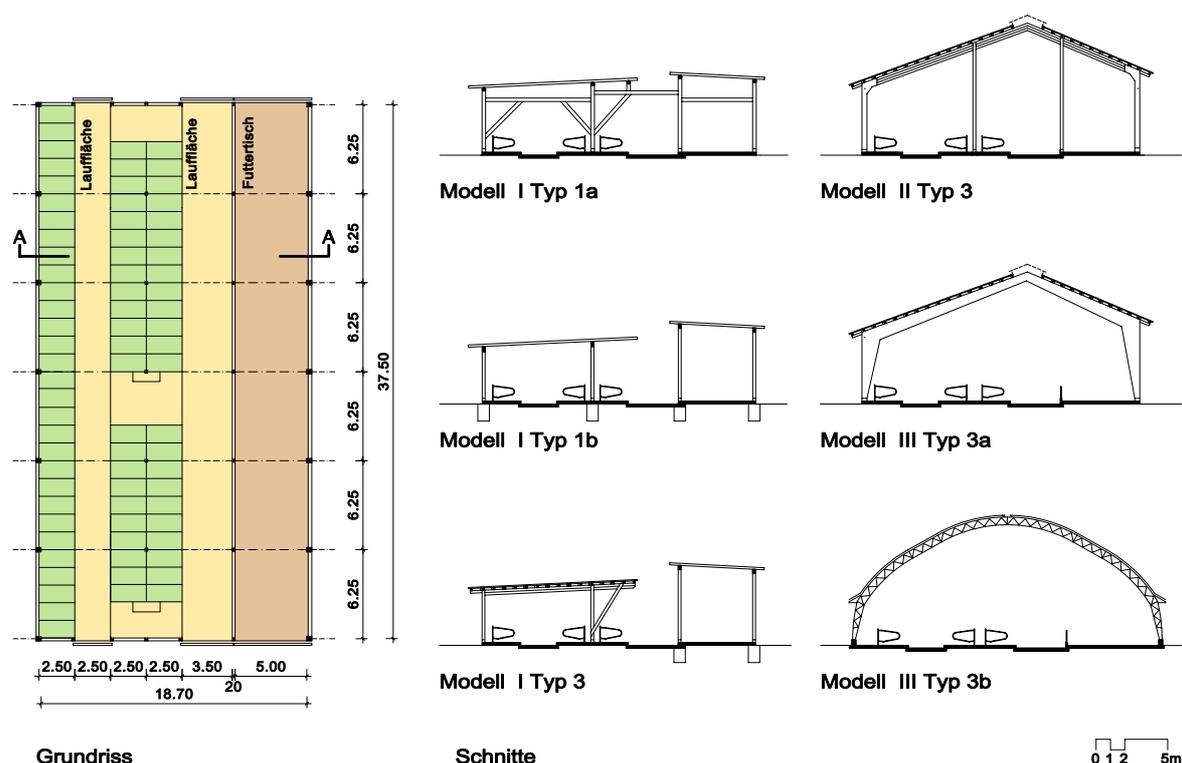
Grundriss und Schnitte der Stallmodelle I – III
